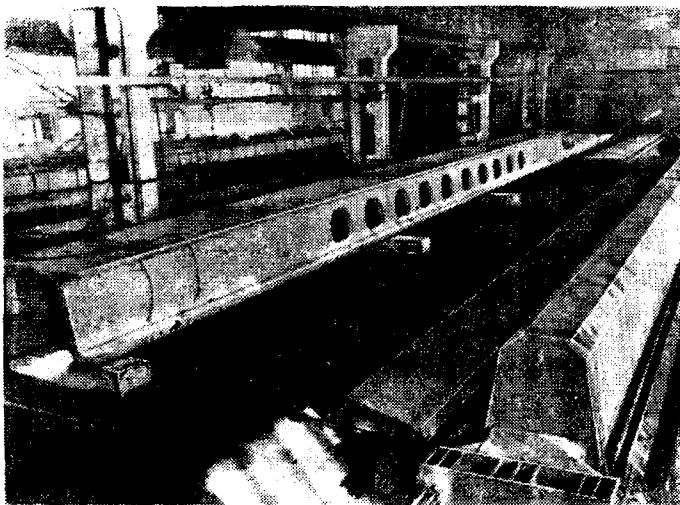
Стенд для изготовления ребристых плит длиной 33 м
